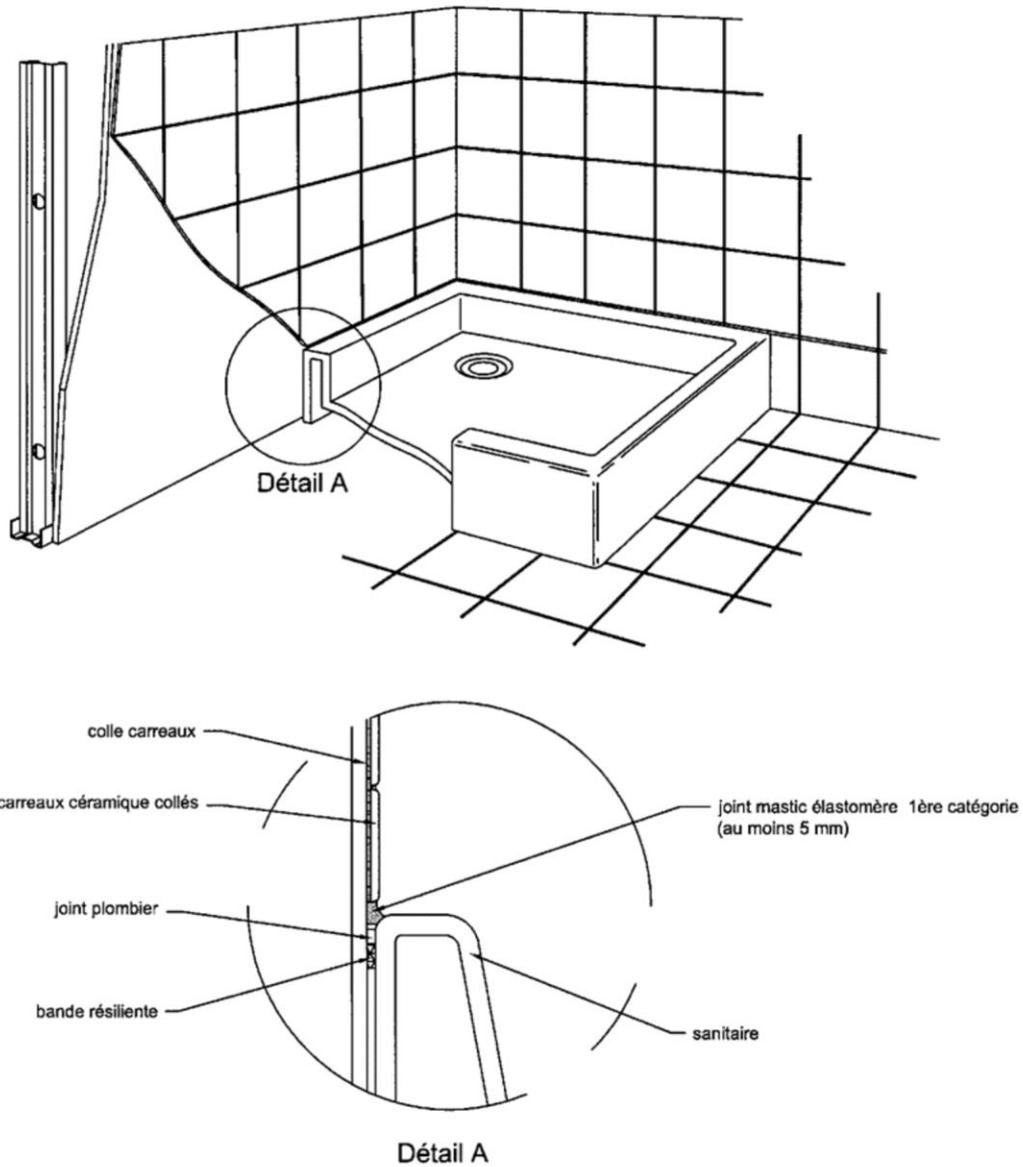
Locaux EC admis – Protection en pied de cloison (Cas de finition par carrelage collé)
